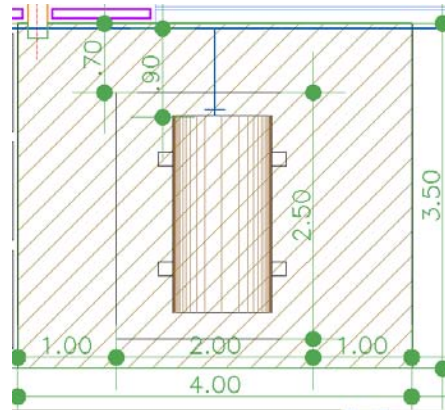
Vista arquitectónica específica del área de lavado y secado
